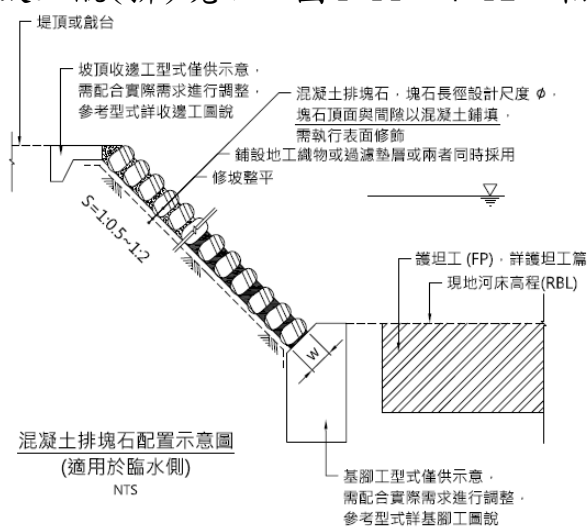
混凝土襯(排)塊石橫斷面示意圖
